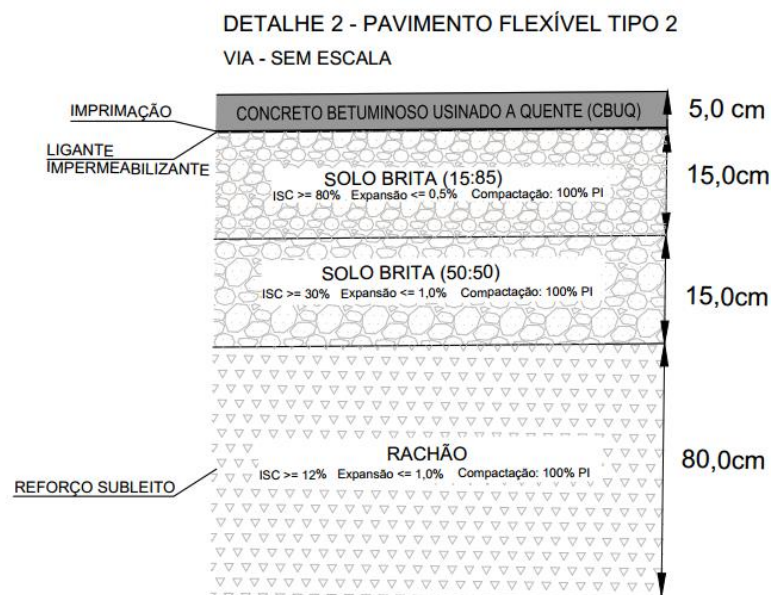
Pavimento Flexível Tipo 2 (com Reforço do Subleito)
